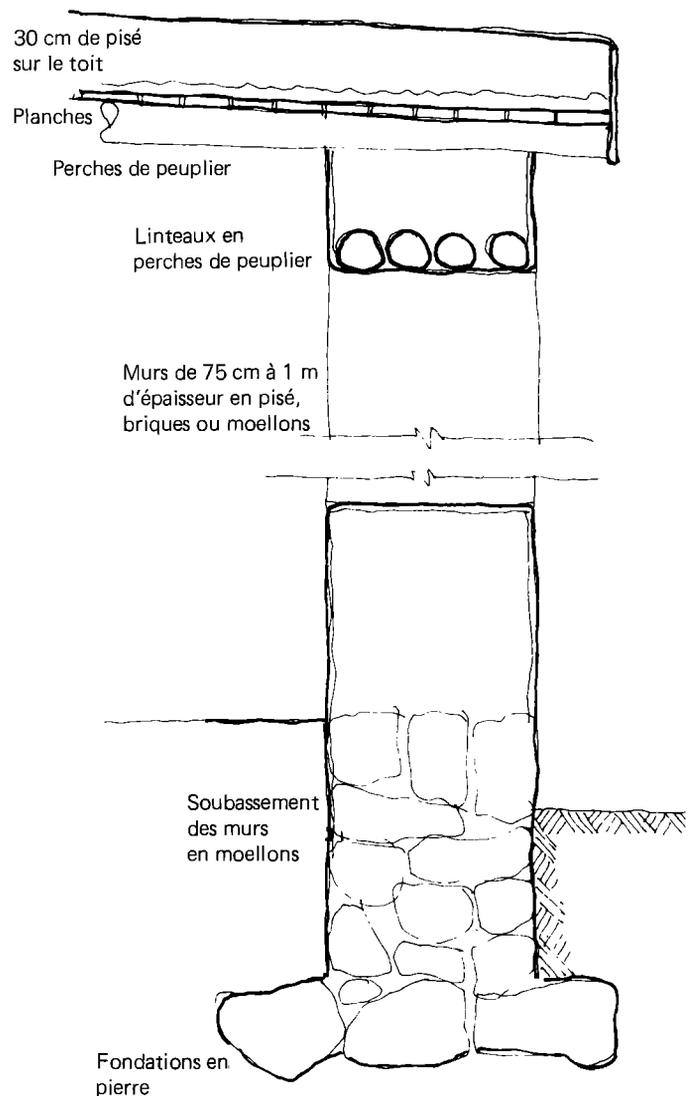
Principes de construction d'une école rurale afghane traditionnelle.
